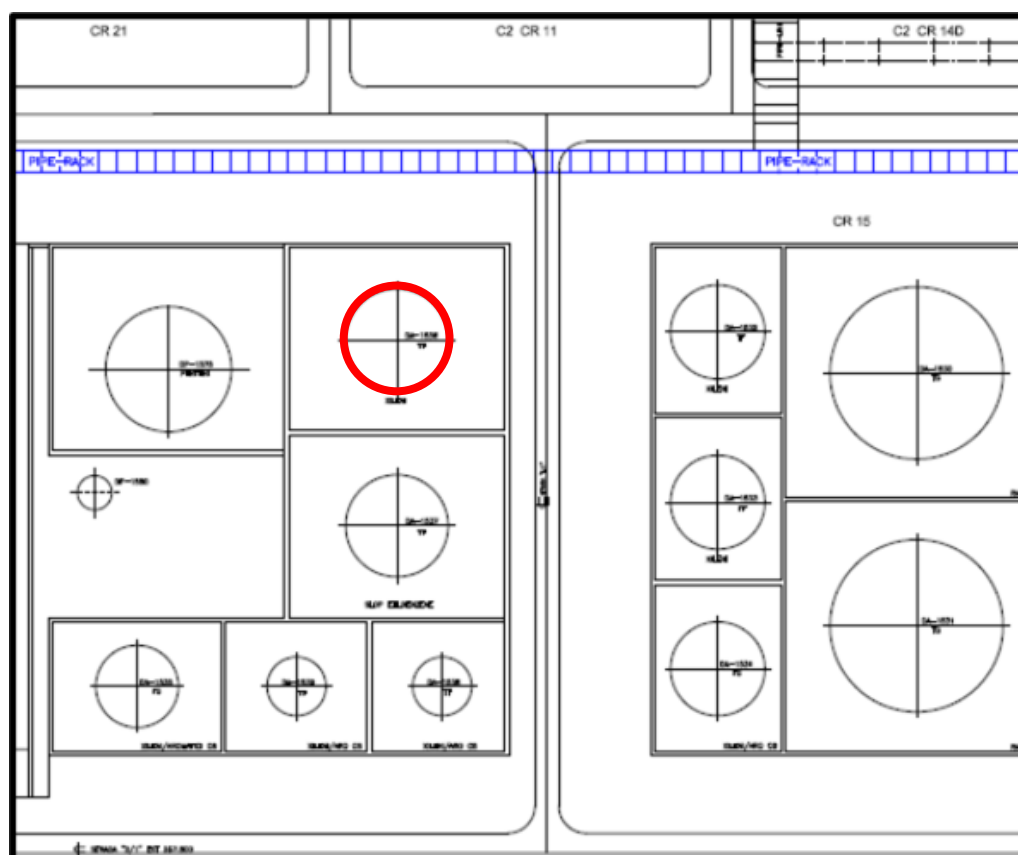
Stralcio planimetrico del serbatoio DA-1536 in area CR15
